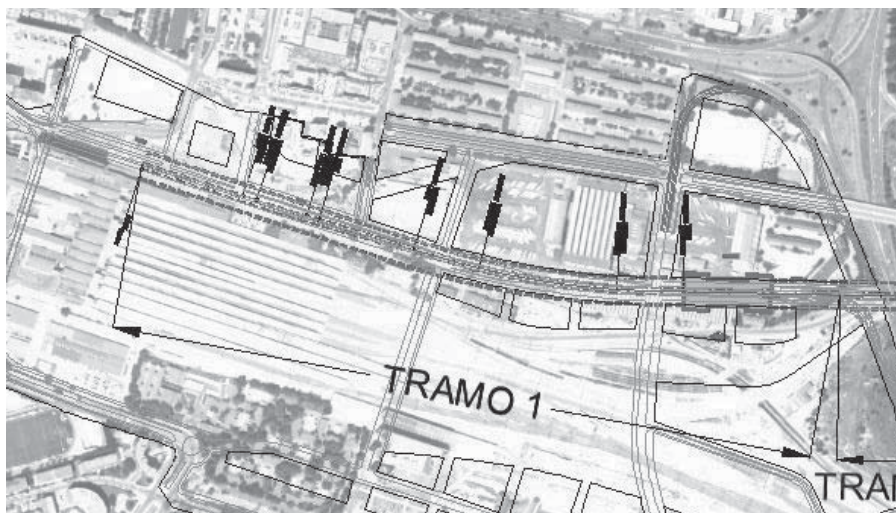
Planta y perfil tramo 1 nueva línea de Metro
